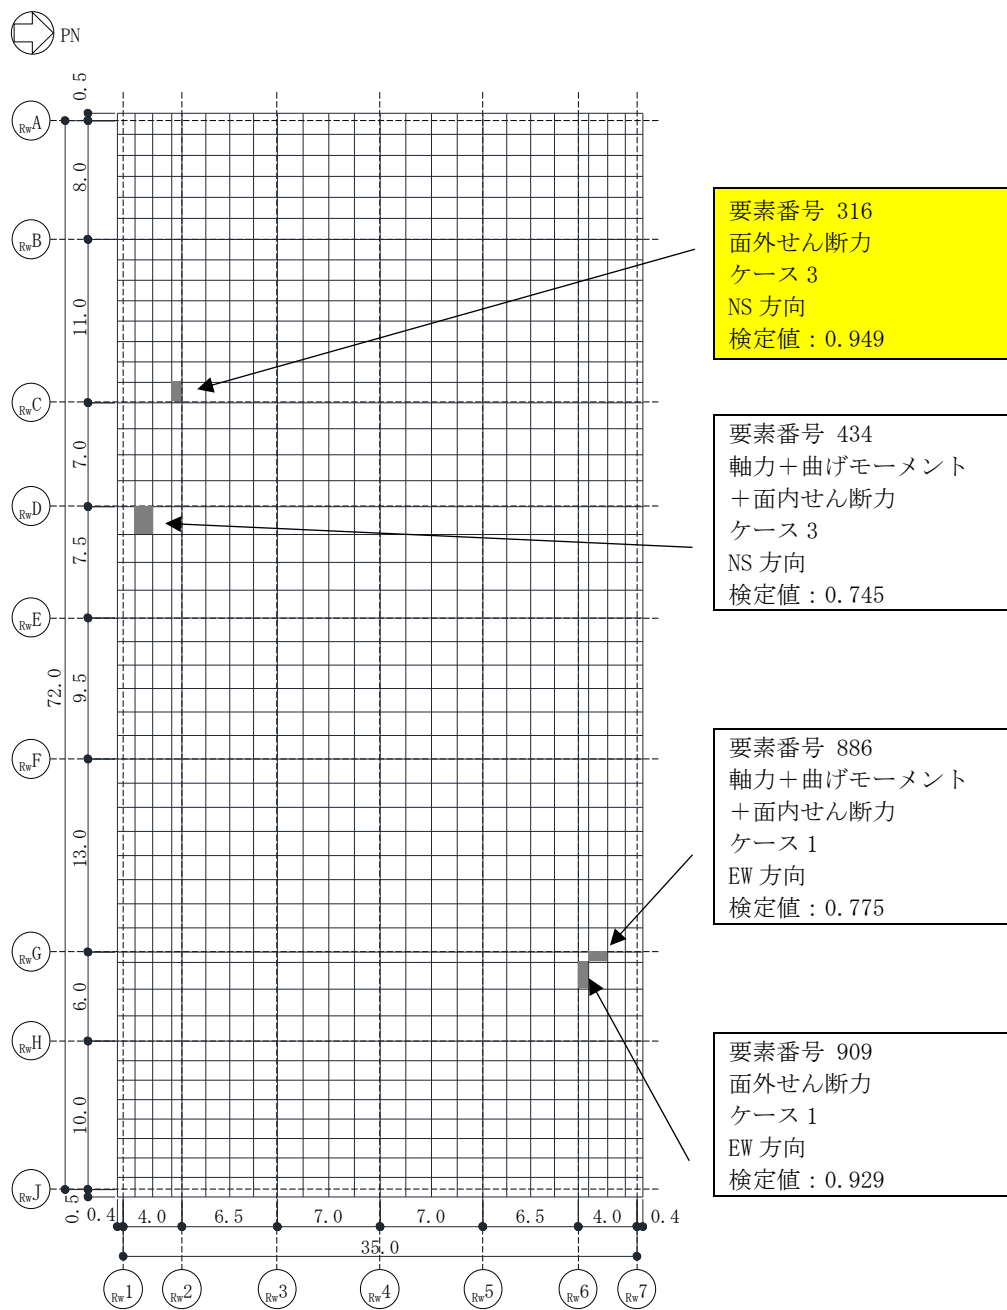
基礎スラブの配筋領域図 (せん断補強筋)
